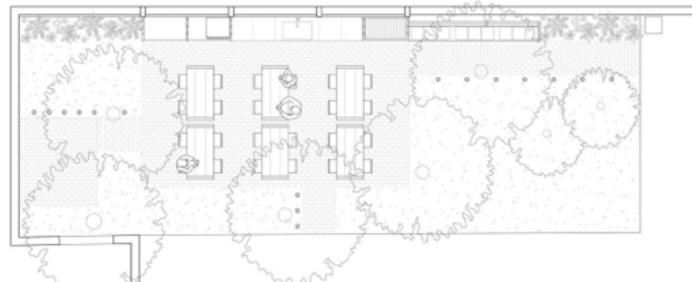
Planos Arquitectónicos del restaurante "La Pesca"
